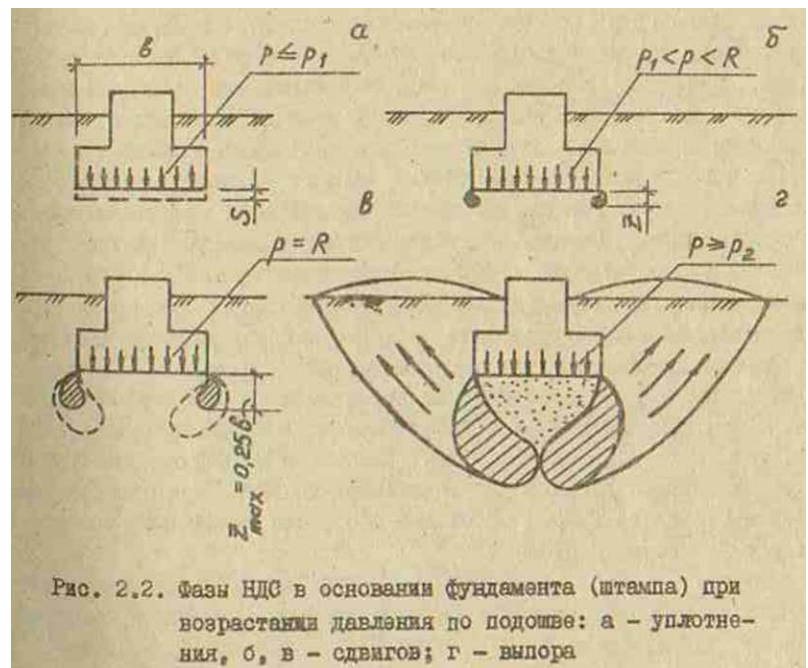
Фазы НДС в основании фундамента (штампа) при возрастании давления по подошве: а - уплотнения, б, в - сдвигов; г - выпора
